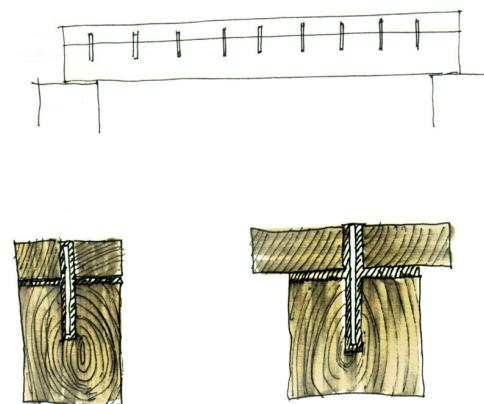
Modificação da secção inicial aumentando a sua altura original ou adaptação para secção em "T"
